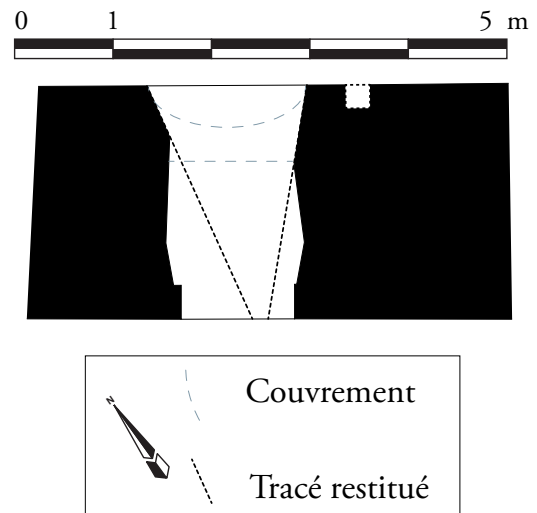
Plan de la porte du mur sud (UM1-1-UC2)
